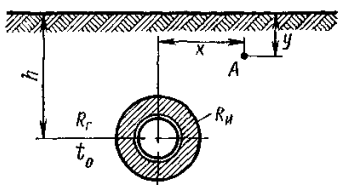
Расчетная схема бесканального однетрубного теплопровода
